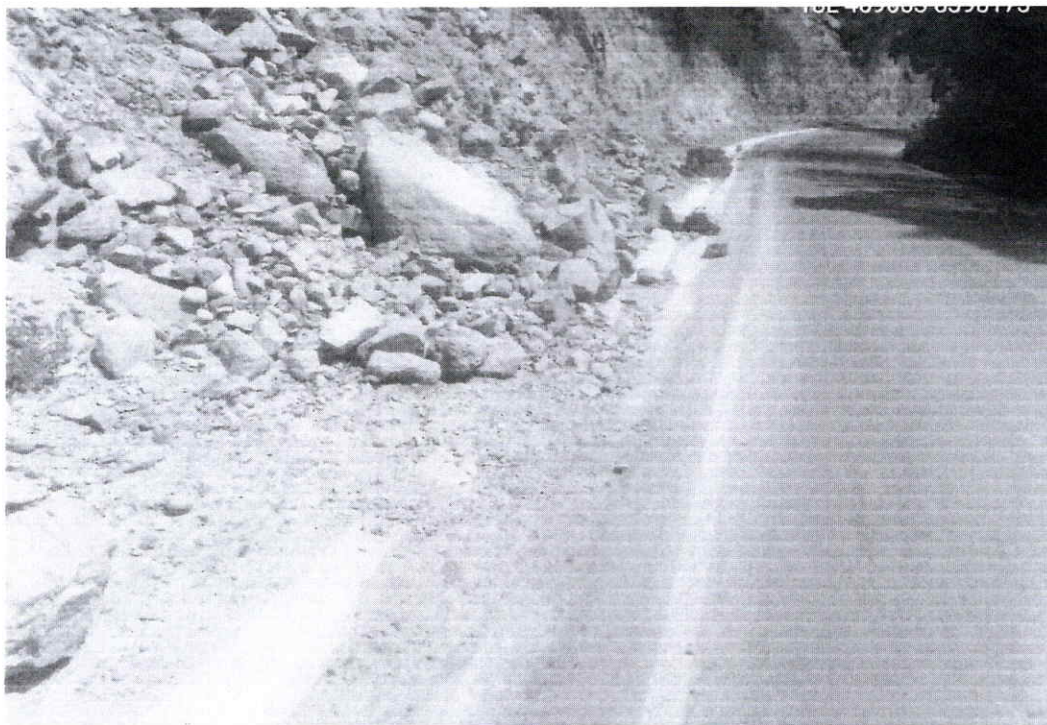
KM 14+720 SE REQUIERE ELIMINACION DE DERRUMBES LADO DERECHO DE VIA.
